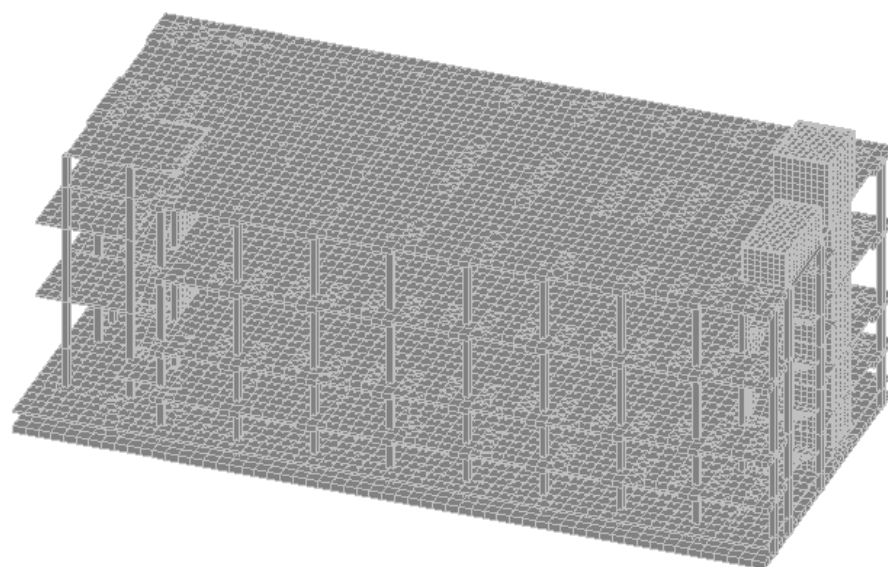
Расчетная схема каркаса здания с плитным фундаментом
